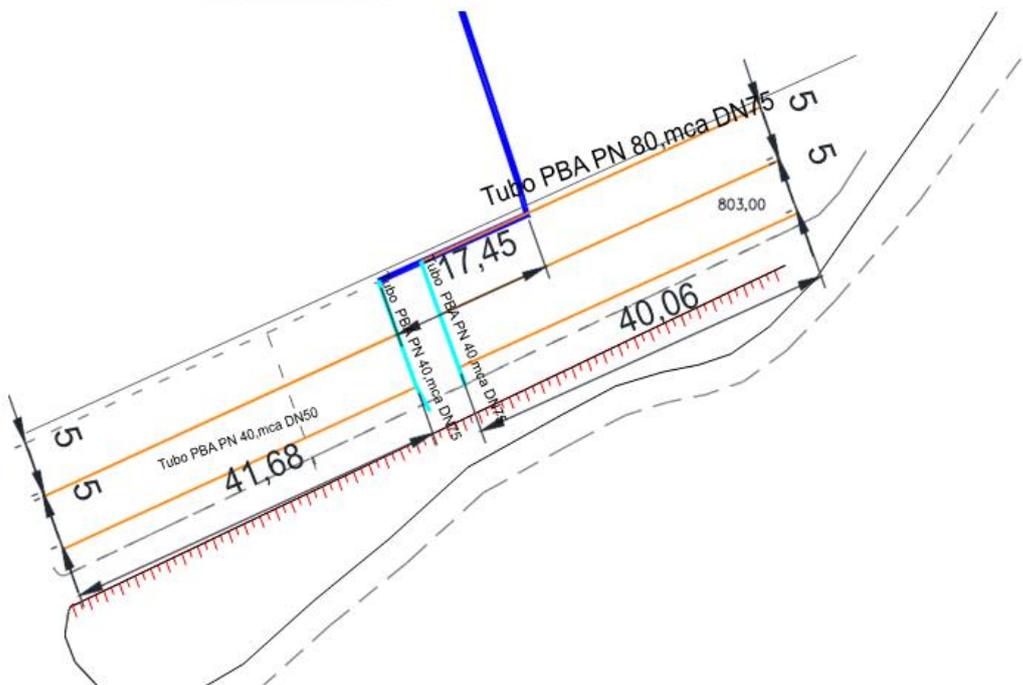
Detalhe da rede dos Setores nº 16 e 17, no platô da elevação 803,00.
